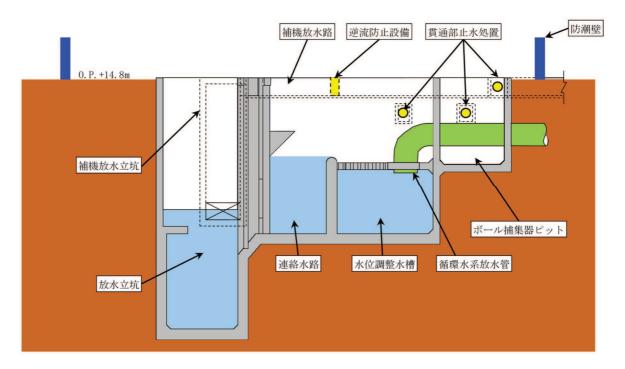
放水立坑付近詳細図 (図 4-3-1 断面図:断面 B-B)
